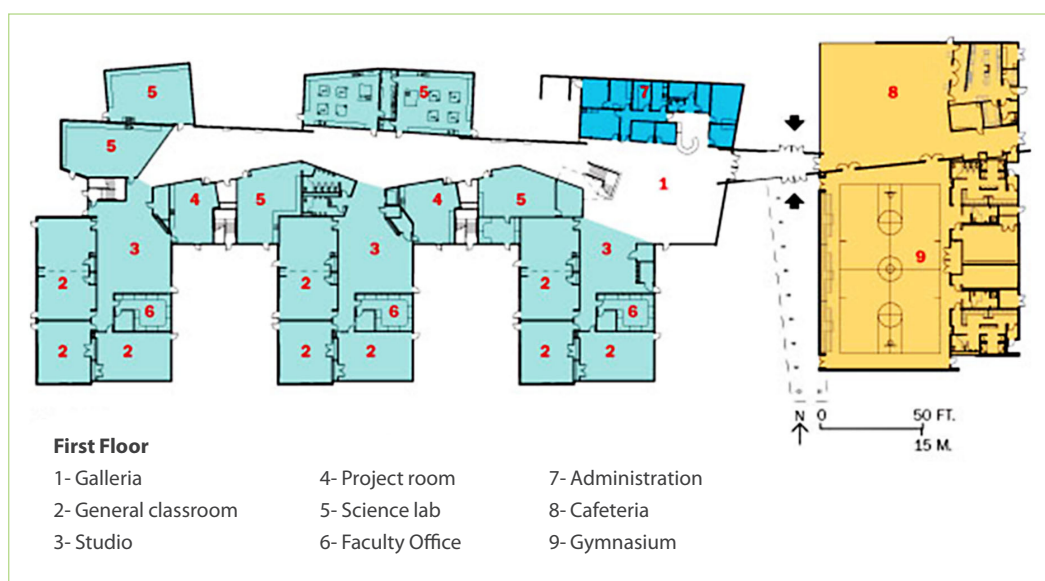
Circulação com paredes não paralelas, em planta
